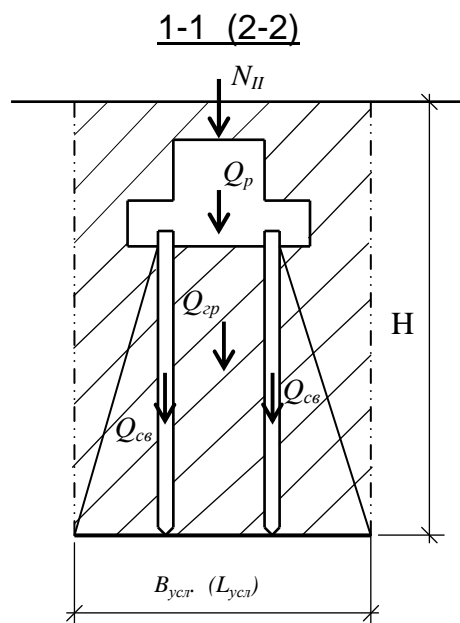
Схема к расчету среднего давления под подошвой условного свайного фундамента
